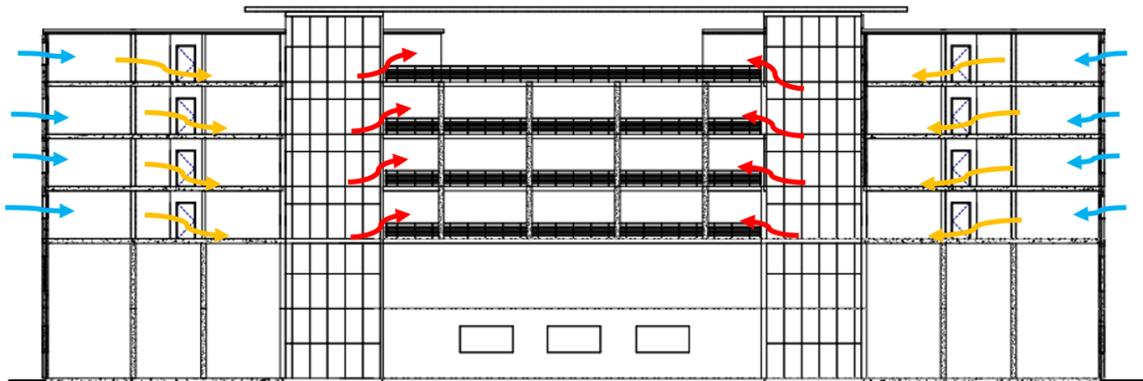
la ventilation naturelle (source : auteur) ➔ Air frais ➔ Air chaud
